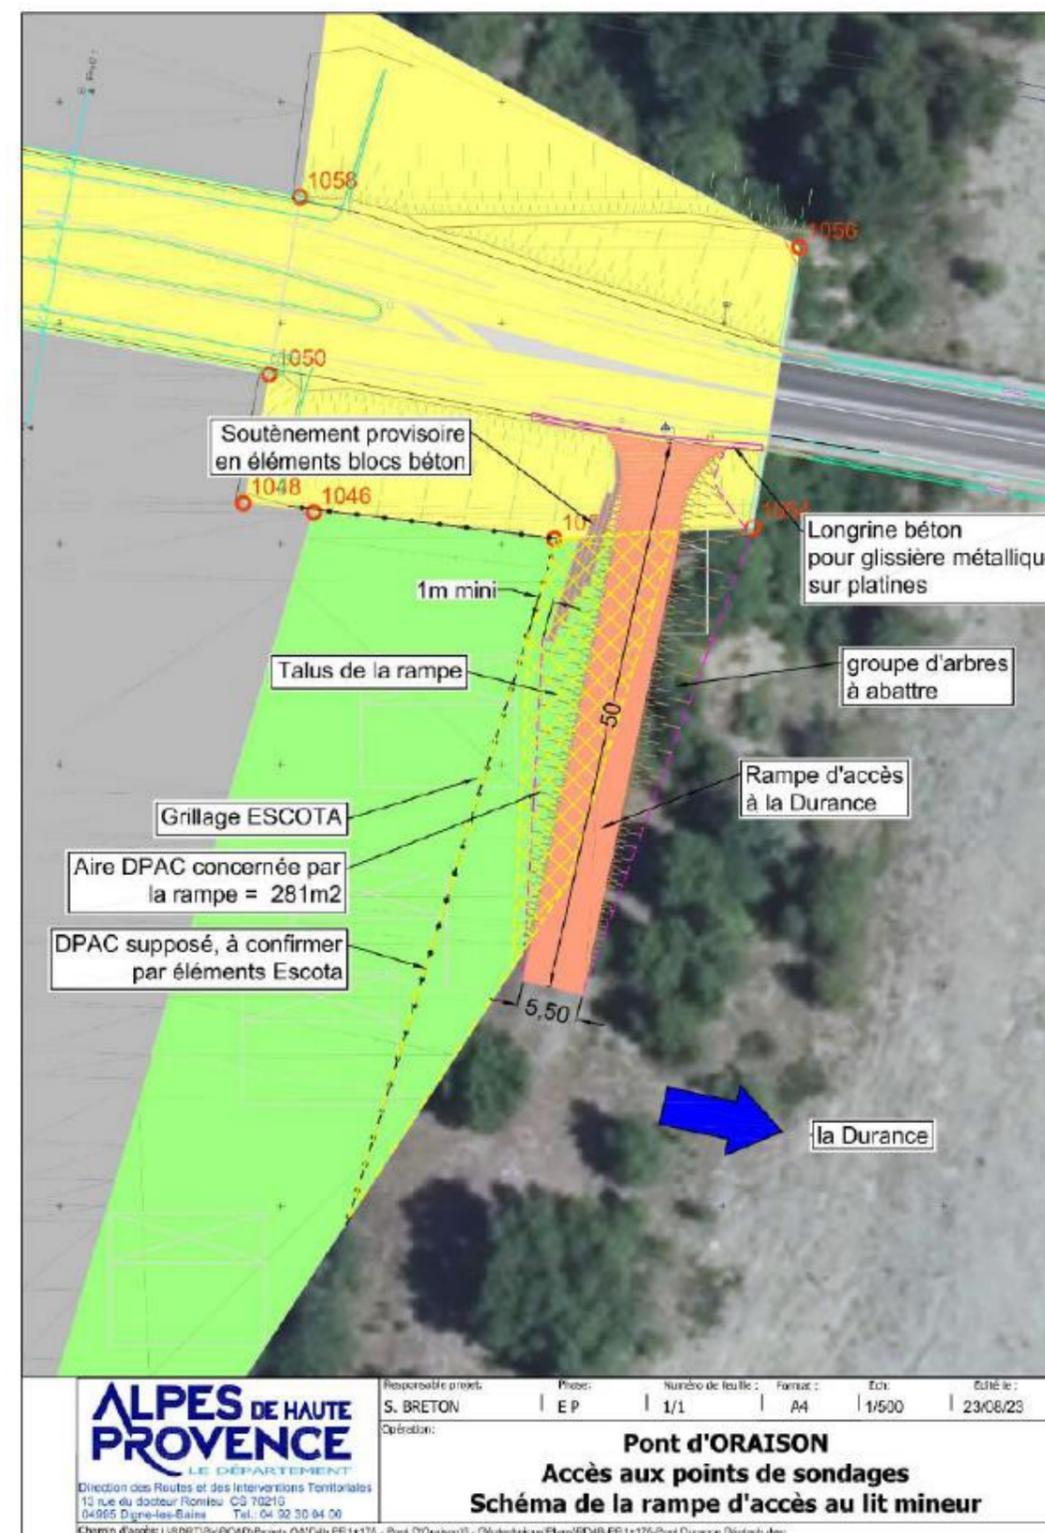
Rampe d'accès depuis la RD4b à l'installation de chantier en rive droite
